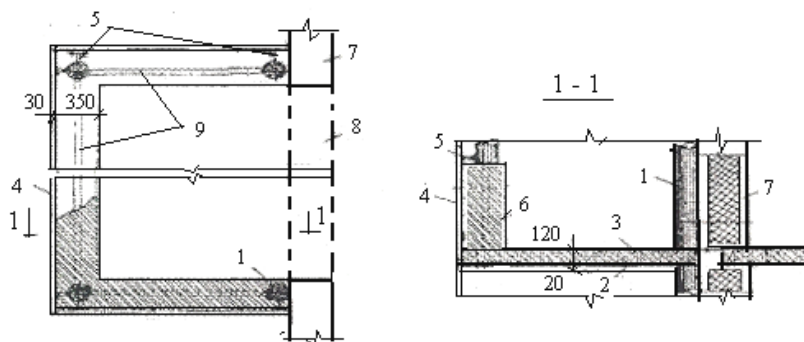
Конструктивно-технологическая схема возведения пристройки с использованием каркаса из трубобетона:
